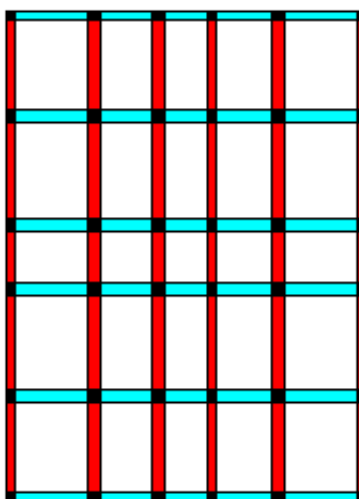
Disposición de las columnas y vigas en el sistema estructural de los edificios convencionales
